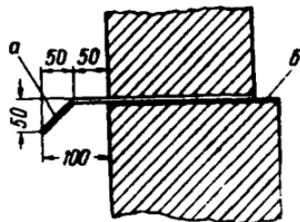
Деталь закладки на цоколь противотермитного защитного щитка
